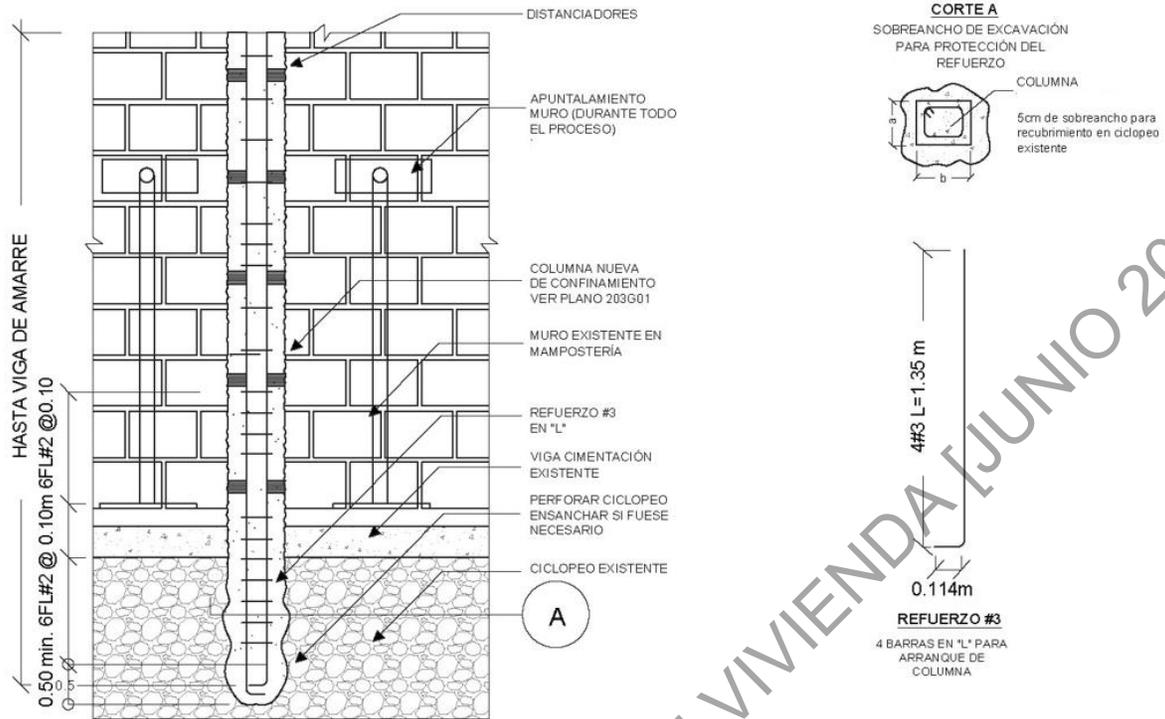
Anclaje de nueva columna de confinamiento a cimentación existente.
